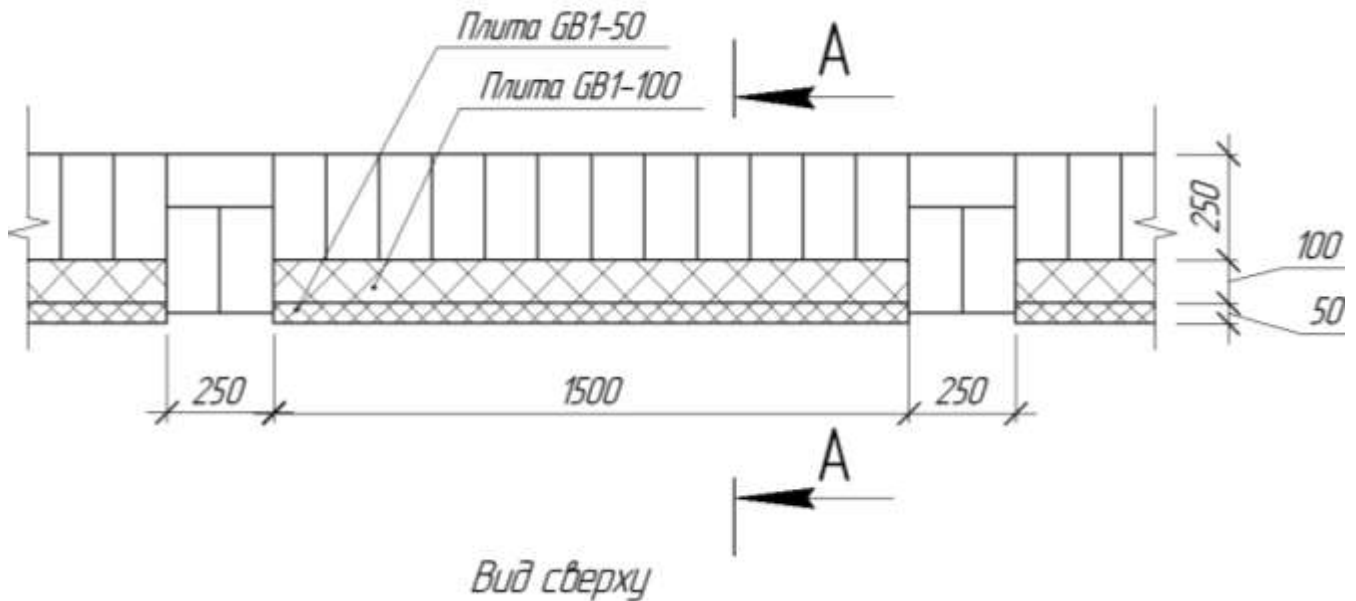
Монтаж утеплителя (общий вид стены)
